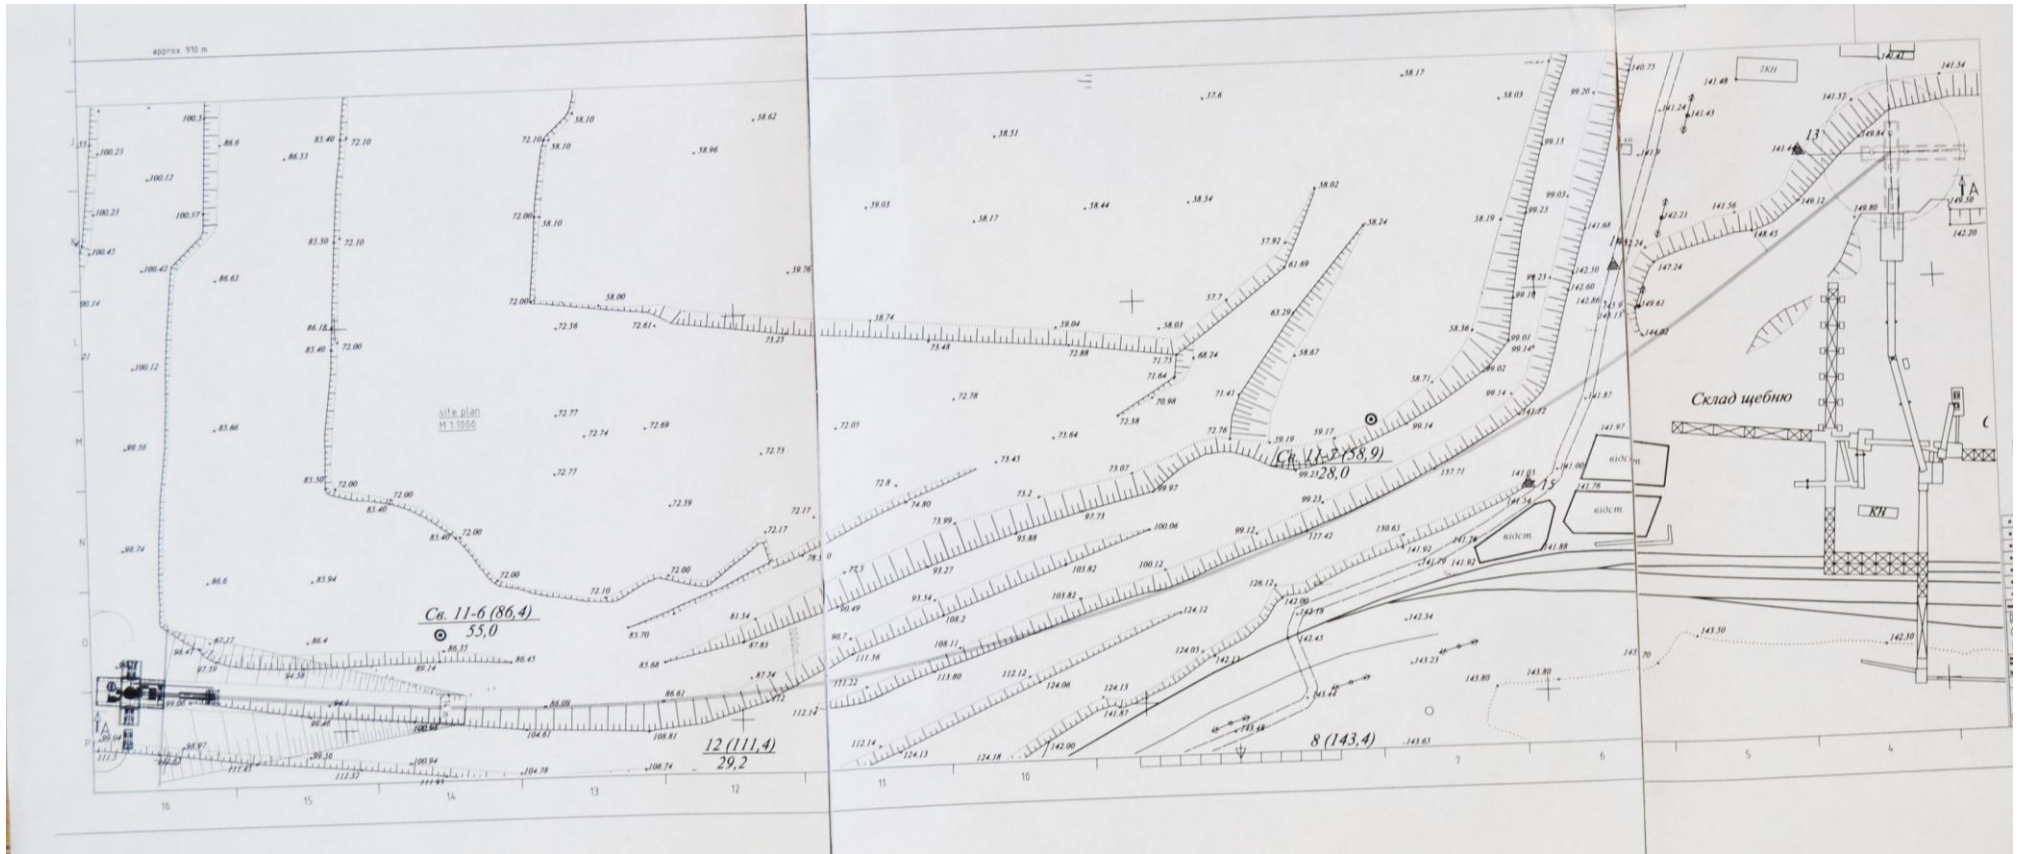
Ескіз розташування крутопохилого конвеєра та дробарки на неробочому борту кар'єра ПАТ «Малинський каменедробильний завод»
